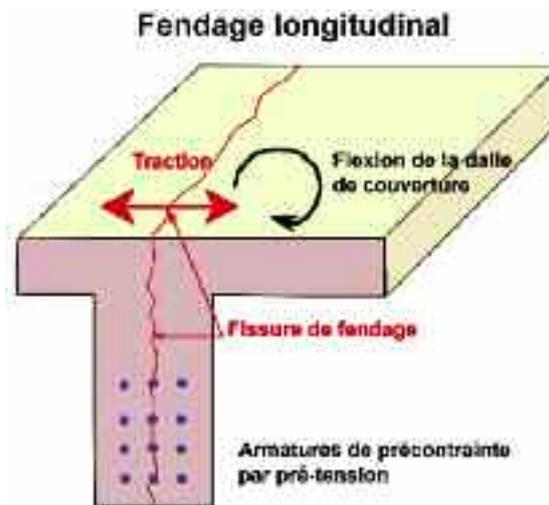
fendage longitudinal d'une poutre préfabriquée précontrainte par pré-tension
